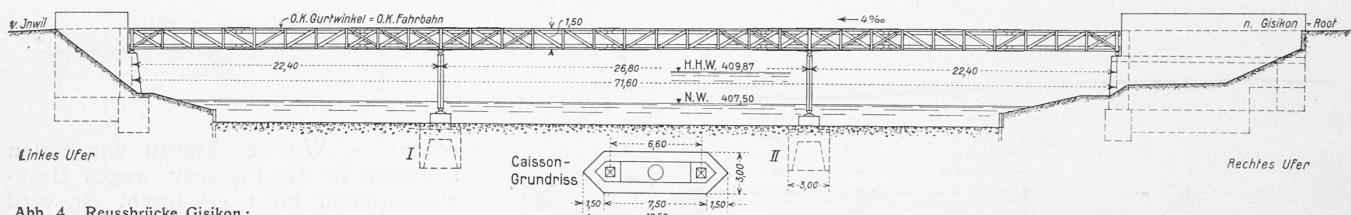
Reussbrücke Gisikon ; Ansicht des Stahlskeletts und Fundationen. — Masstab 1 : 500.
